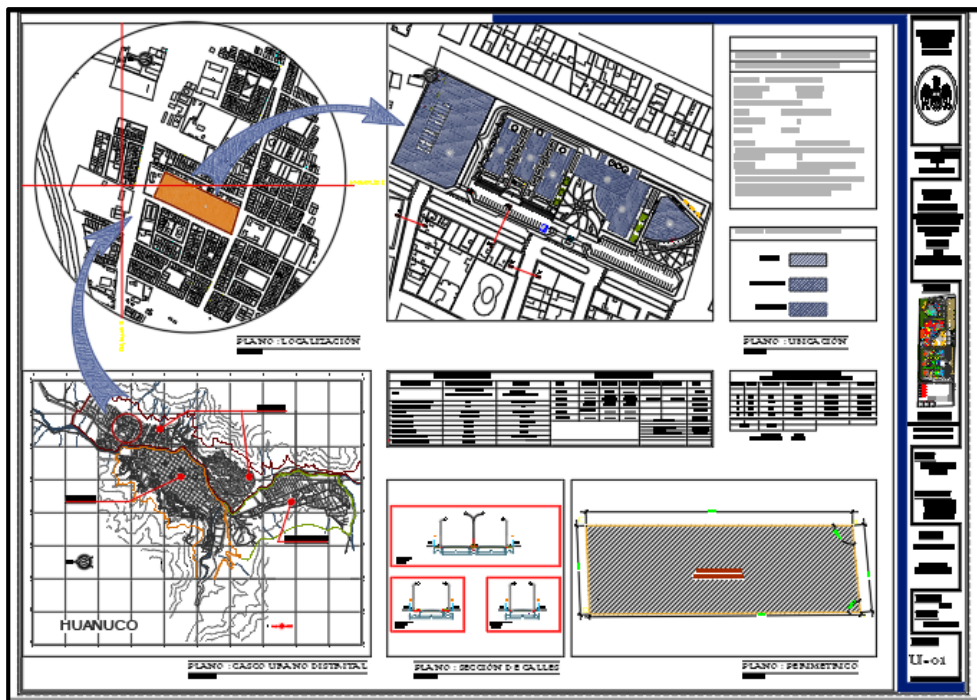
Vista del Plano de Ubicación de la Propuesta.
